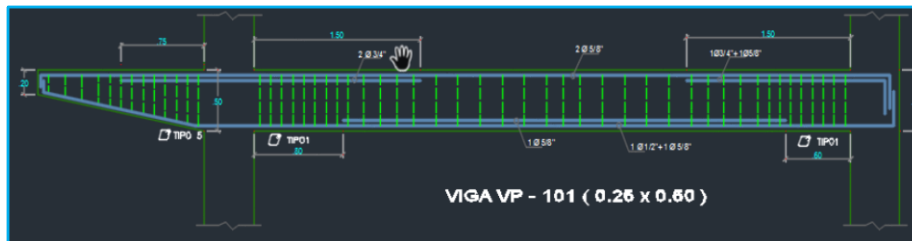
Detalle de las dimensiones de la viga VP-101 y el acero de refuerzo
